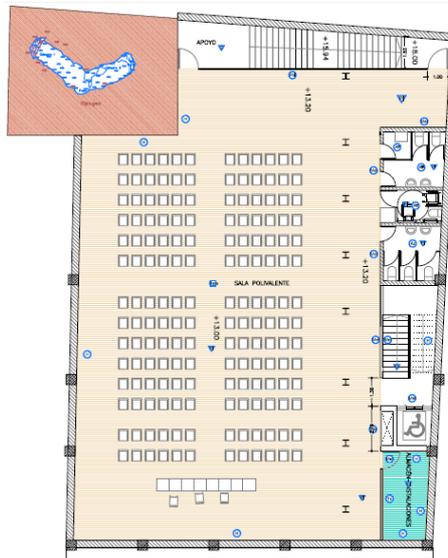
Planta Sótano -1 de la Casa del Estudiante
